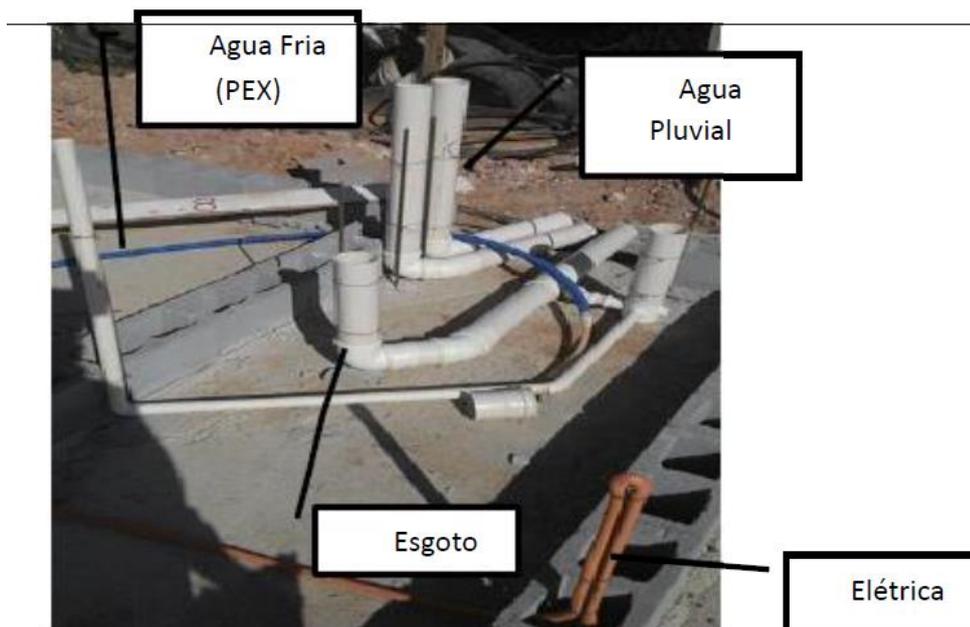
Processo de montagem da Hidráulica e Elétrica.
